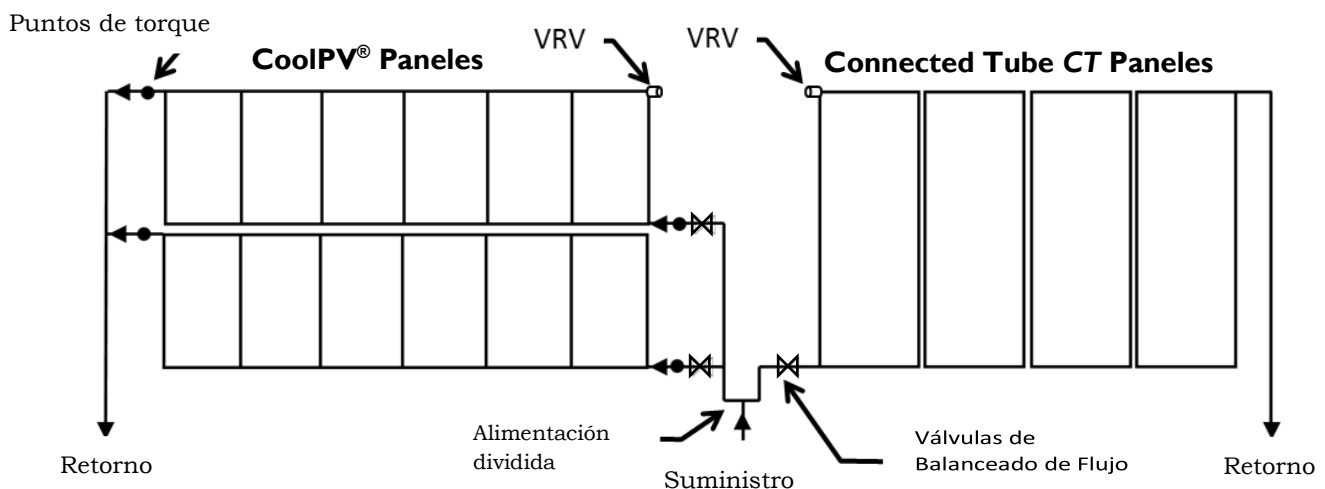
| CoolPV híbrido® y tubo conectado CT Esquema de plomería
